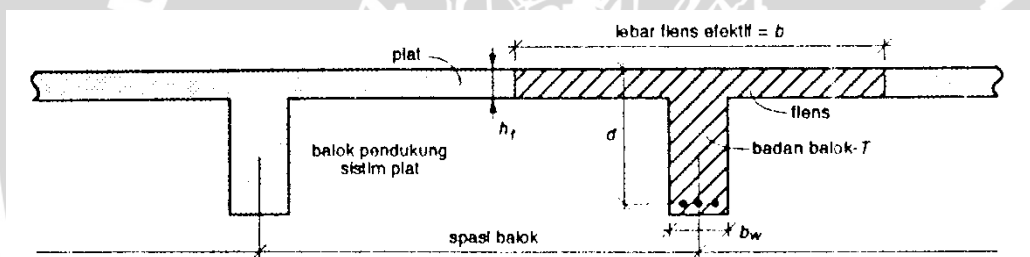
Sistem Balok dan Balok Induk Lantai.
